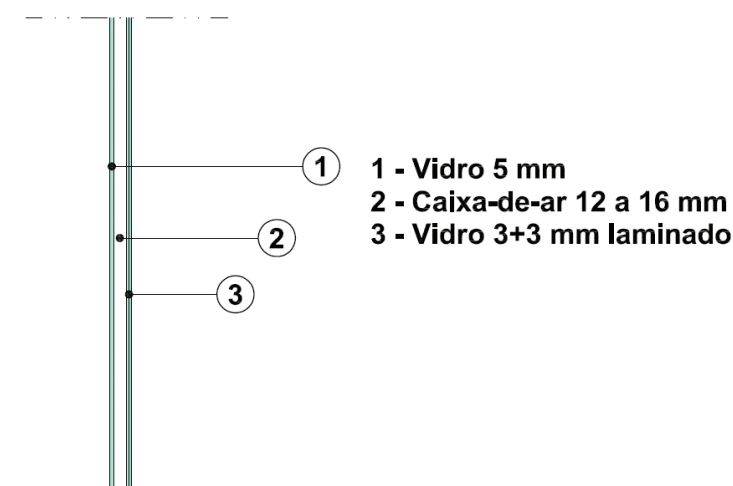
Pormenor construtivo do vidro previsto em projecto.
